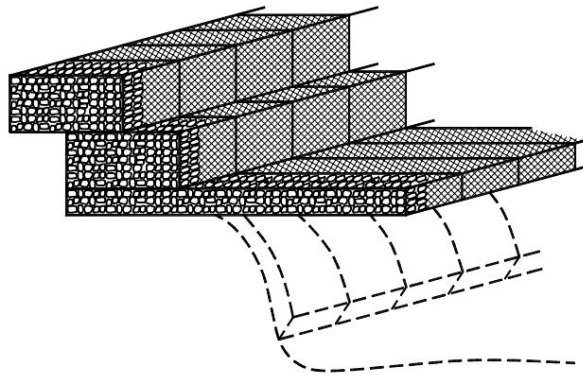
Muros en gaviones para protección de orillas de corrientes.
